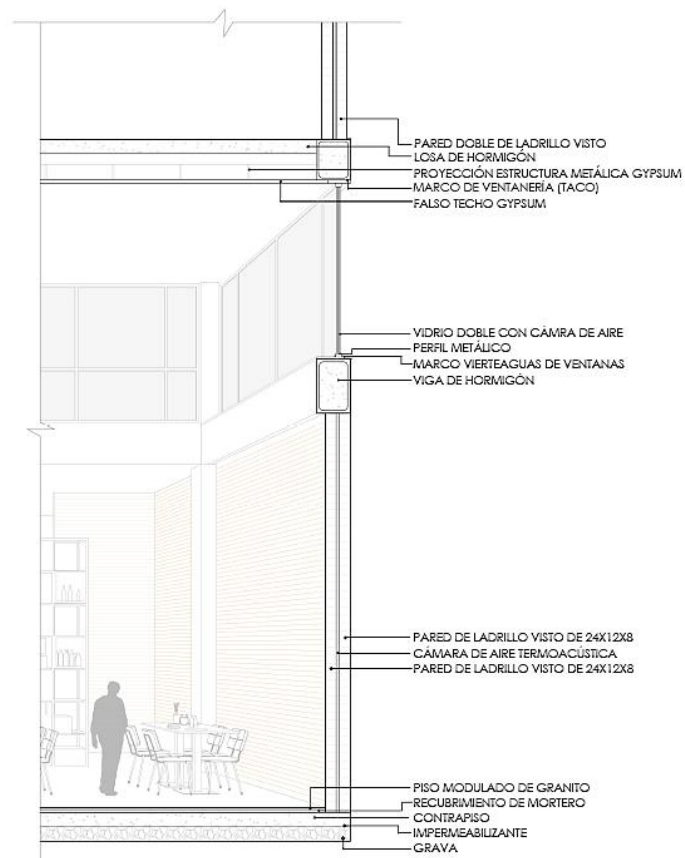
Detalle constructivo pizzería. Elaboración propia.
